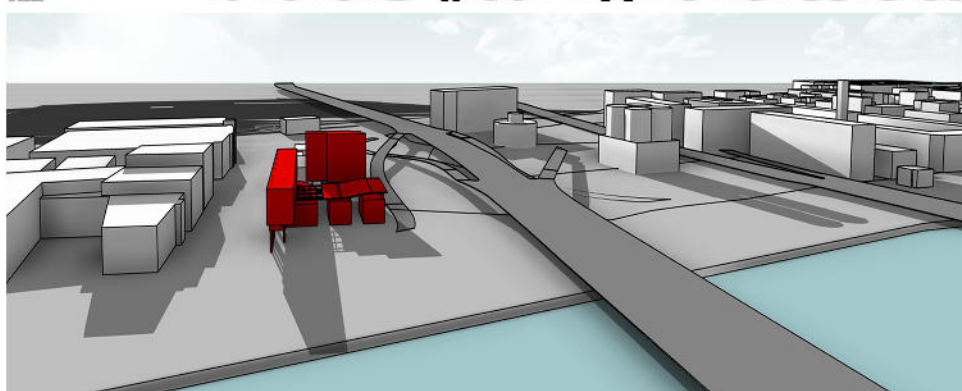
Vista prospettica - Rapporto dell'architettura con il suo contesto
